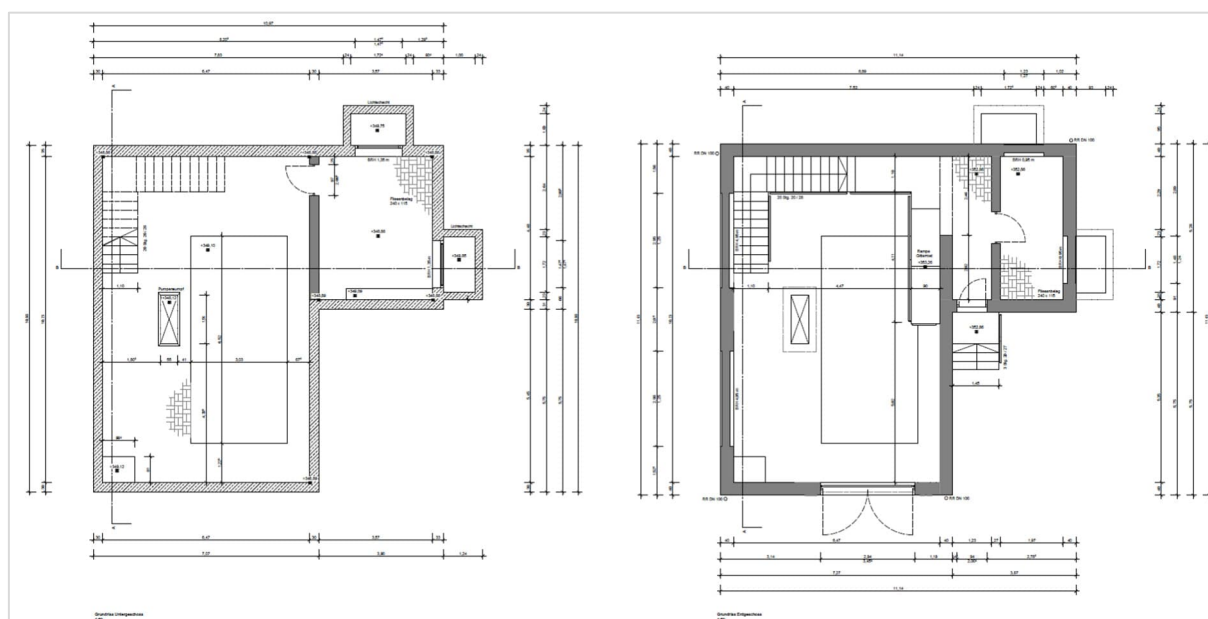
Grundriss Untergeschoss (links) und Erdgeschoss (rechts) Bestandsbauwerk, TWA Schöne Aussicht
